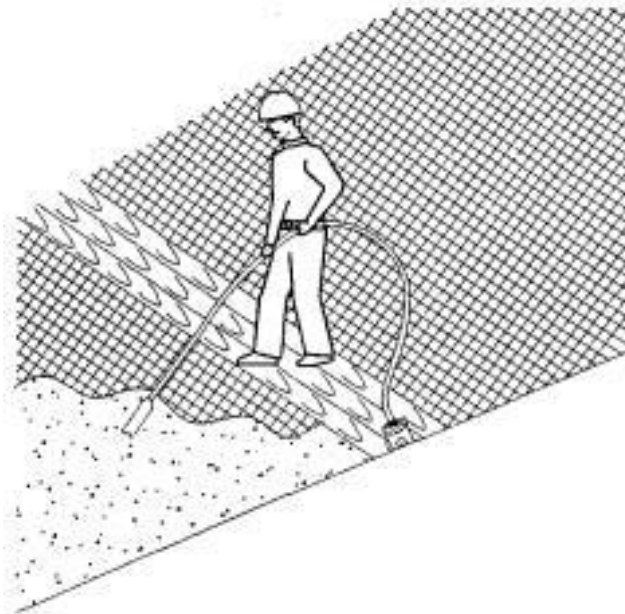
Производство работ по уплотнению бетонной смеси
